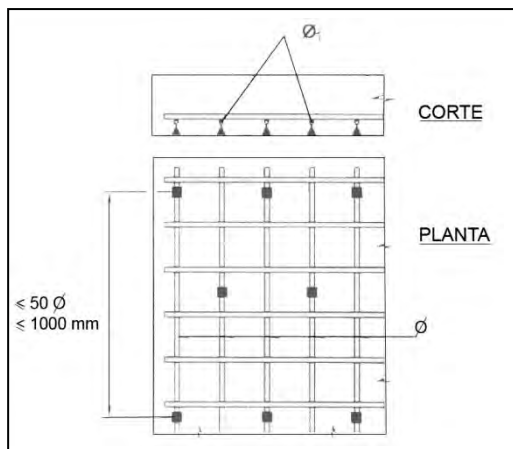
SEPARADORES EN EMPARRILLADO INFERIOR DE LOSA
